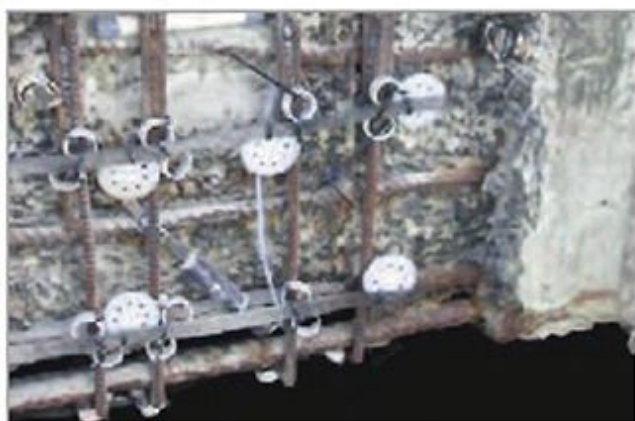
La parte finale della sezione da 3,5 m con un elettrodo di riferimento impiantato a 0,5 m dalla base
